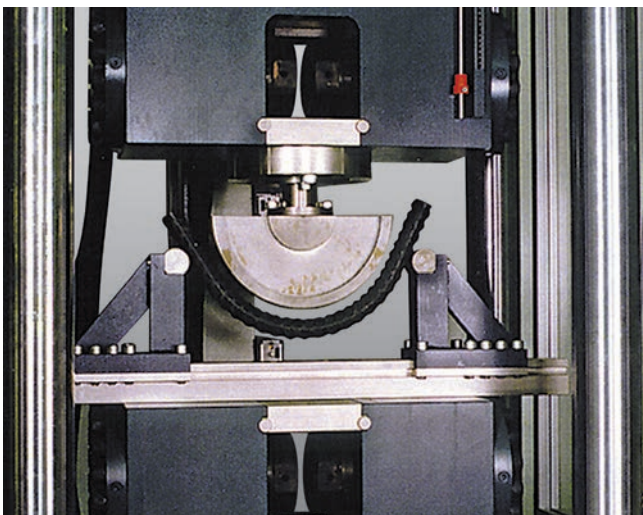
3-Punkt-Biegevorrichtung für Betonrippenstahl
